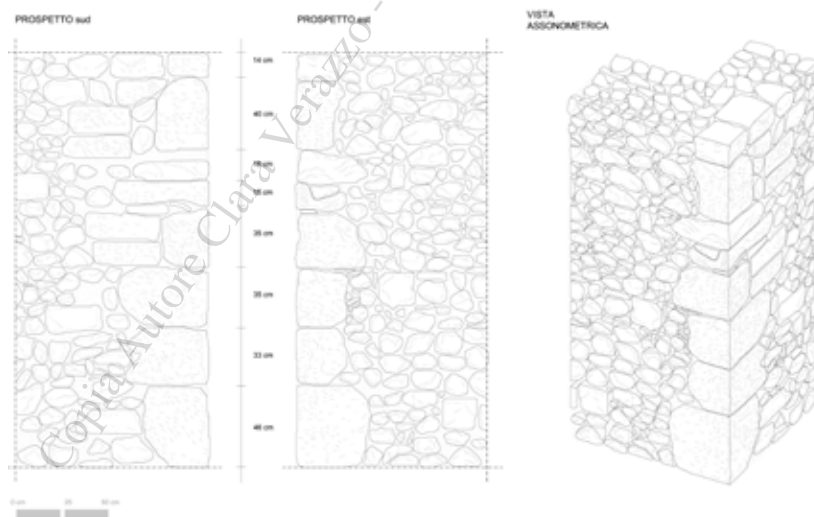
Gagliano Aterno (Aq), edificio su via Torrione, apparecchio murario in blocchi e bozze di calcare con corsi di orizzontamento del prospetto settentrionale (disegno di C. Crocetta, R. Di Censo, S. Giancola, ALabRes, 2012).
